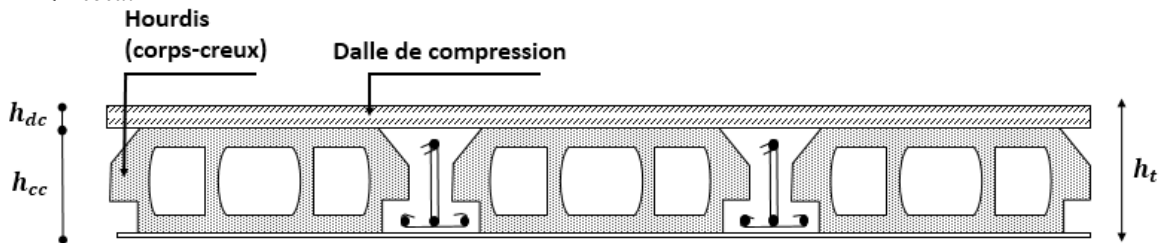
Coupe transversale d'un plancher creux.
